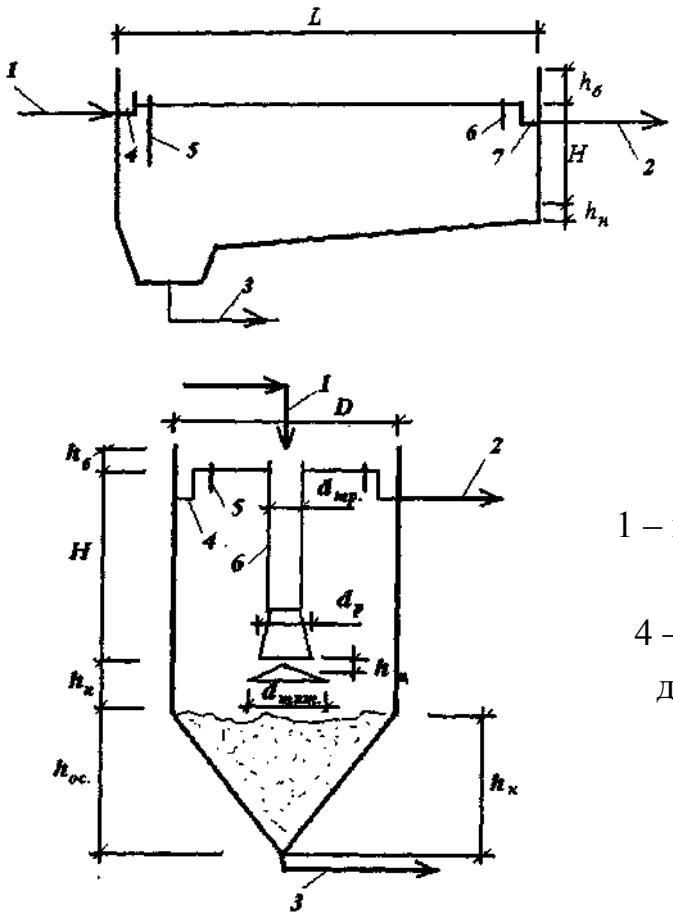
Розрахункова схема горизонтального відстійника:
